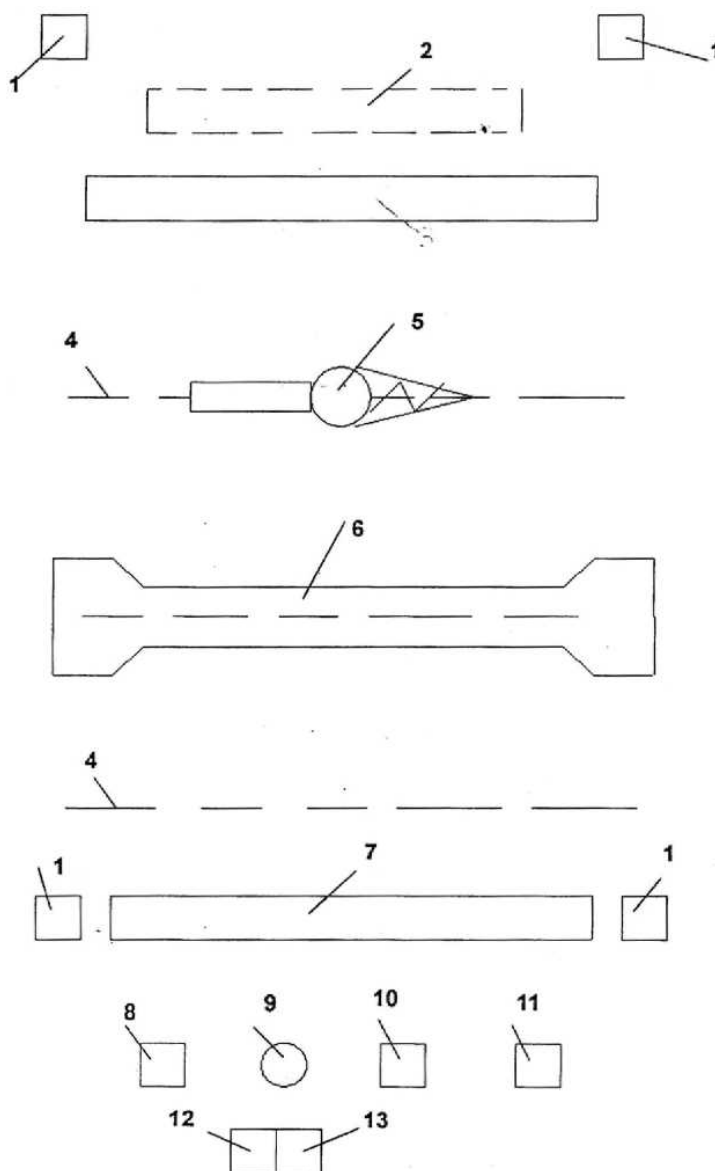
Схема монтажной площадки трубы: 1 – склад блоков оголовков, 2 – склад фундаментов, 3 – склад лекальных блоков, 4 – путь движения крана, 5 – кран, 6 – контур трубы, 7 – склад звеньев трубы, 8 – емкость с цементом, 9 – бетономешалка, 10 – емкость с водой, 11 – электростанция 12 – склад щебня, 13 – склад песка
